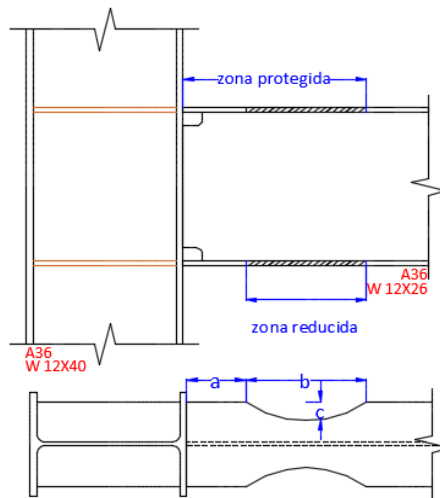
Conexión Viga de Sección Reducida (RBS).
